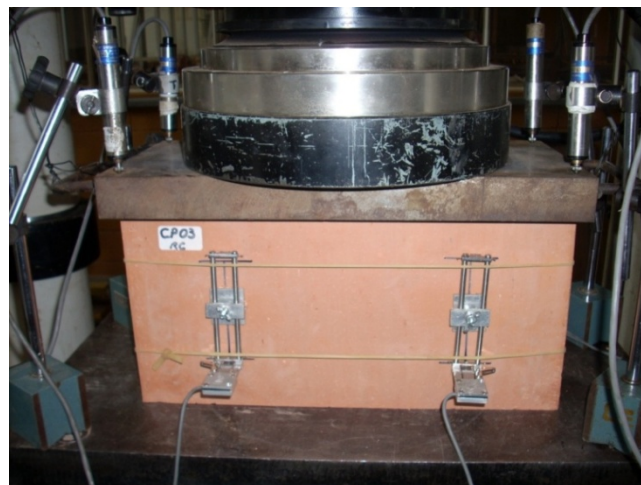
Ensaio de compressão - bloco cerâmico.
